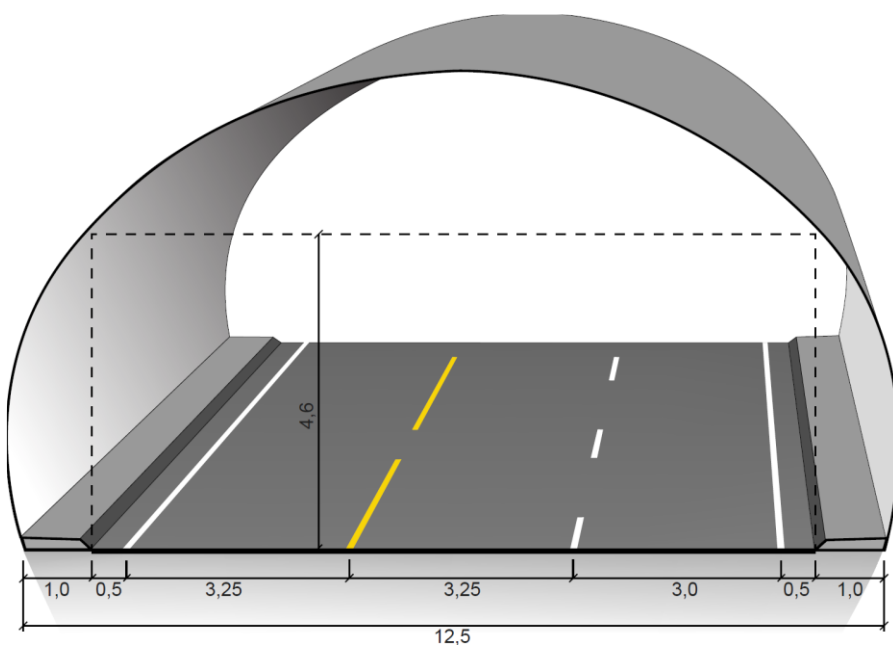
Tunnelprofil T13,5 med havarilomme (mål i m)
